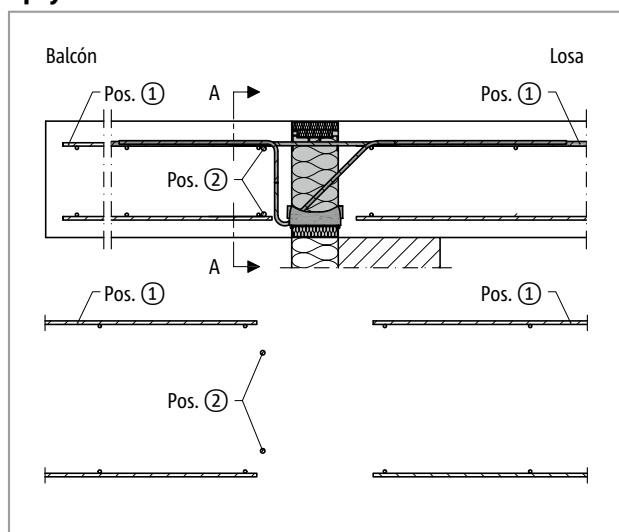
Schöck Isokorb® T tipo K-M1 hasta M11: Armadura in situ en caso de apoyo directo
